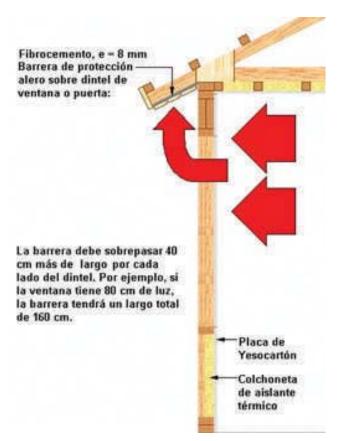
23: Barrera de protección en placa de fibrocemento de 8 mm de espesor bajo alero para evitar penetración de llamas hacia la estructura de techumbre bajo la cubierta.
